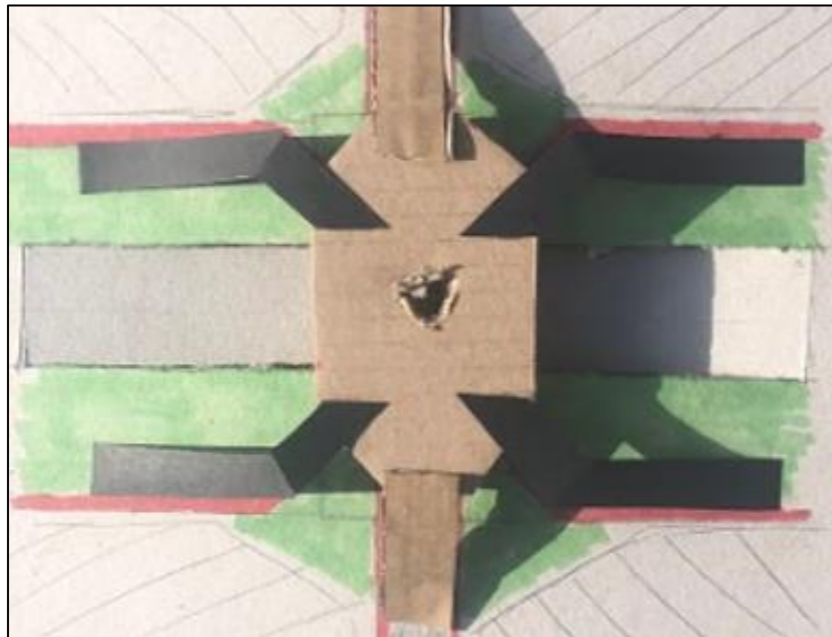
Bovenanzicht tunnelsysteem
